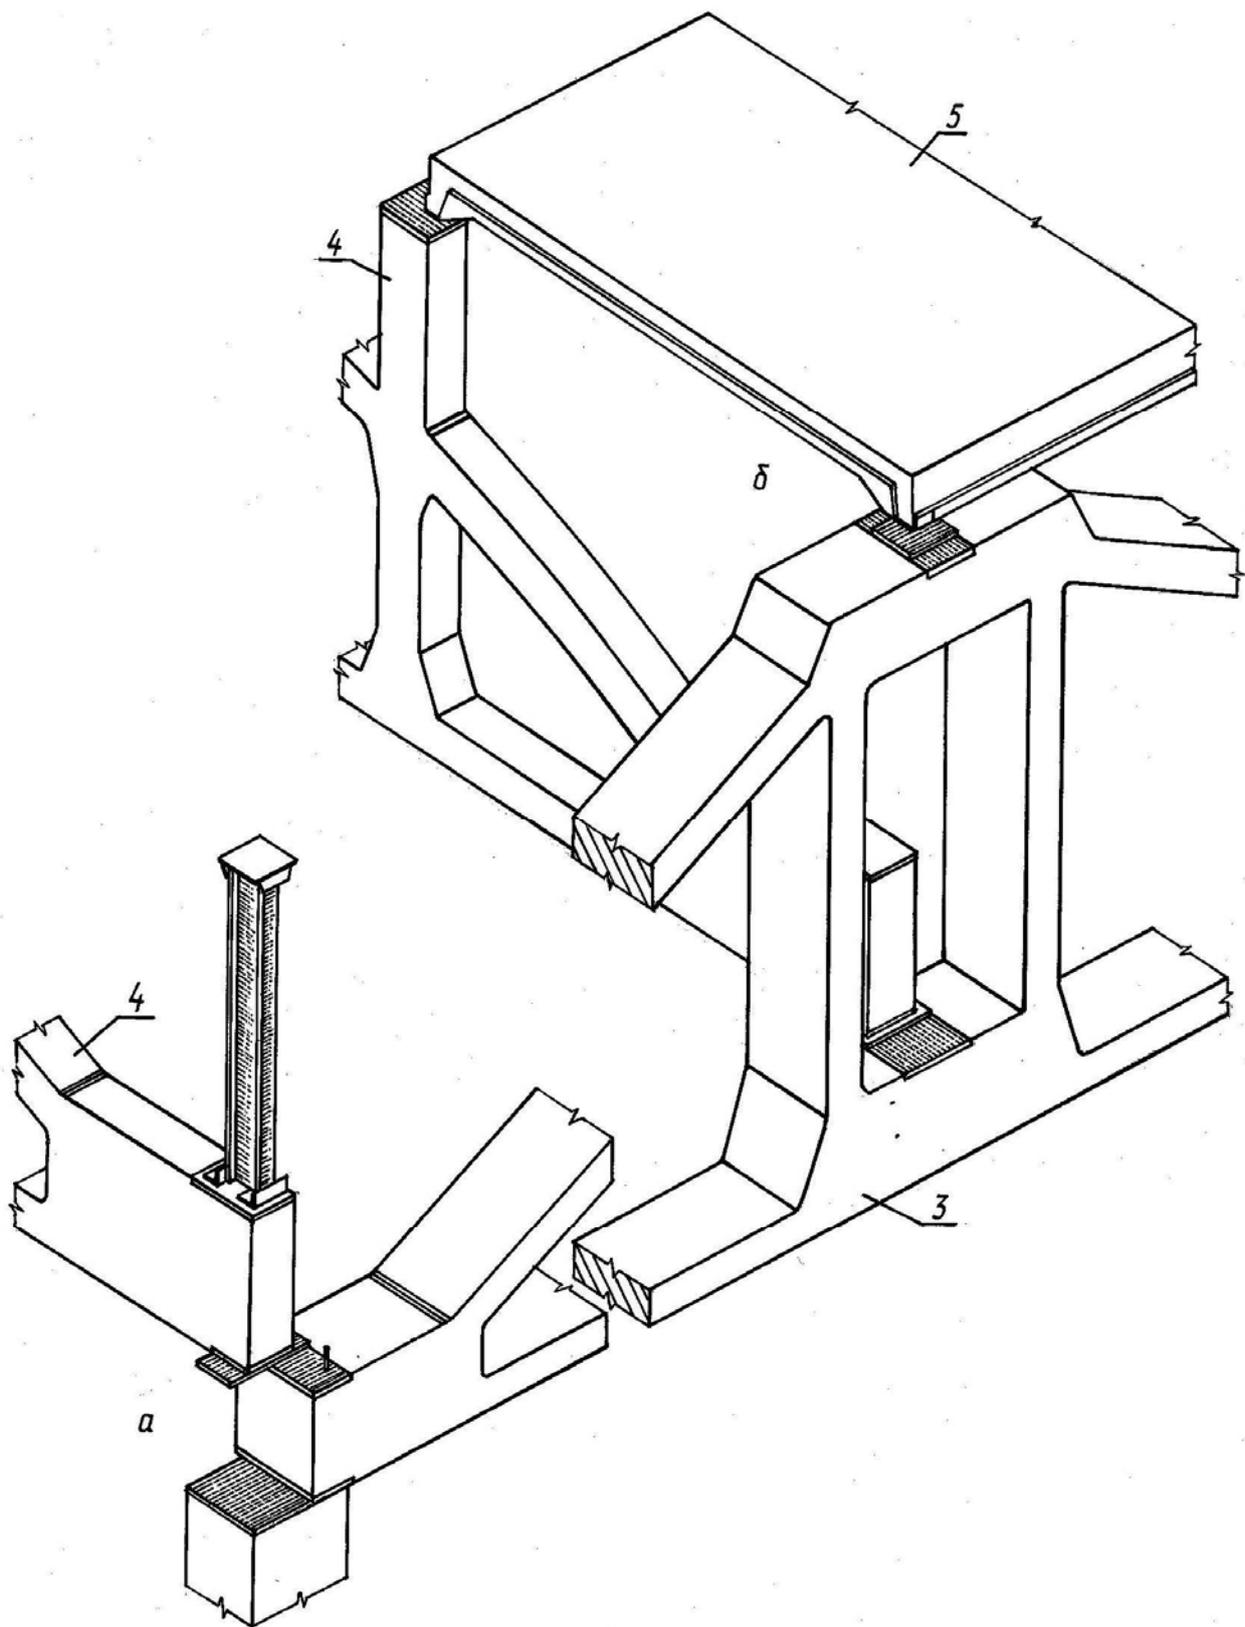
Узлы сопряжения конструкций покрытия с колонной среднего ряда: узлы опирания стропильной и подстропильной ферм на среднюю рядовую колонну (*a*), опирания стропильные фермы на подстропильную (*б*) и опирания железобетонной ребристой плиты на стропильную и подстропильную фермы (см. рис. 2.5, позиция 1...5)
